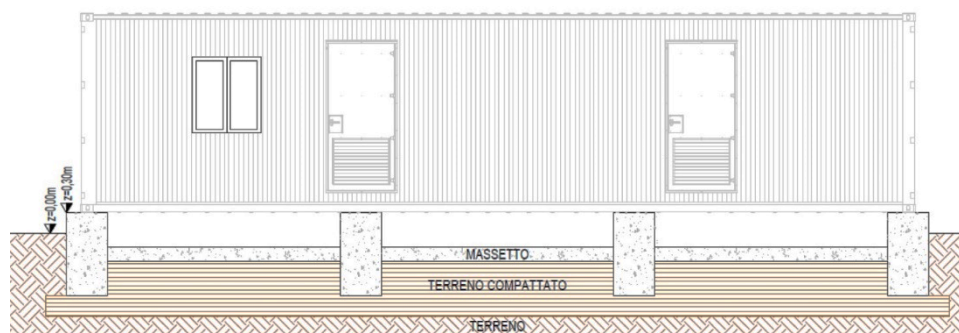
Prospetto di progetto della cabina di smistamento
